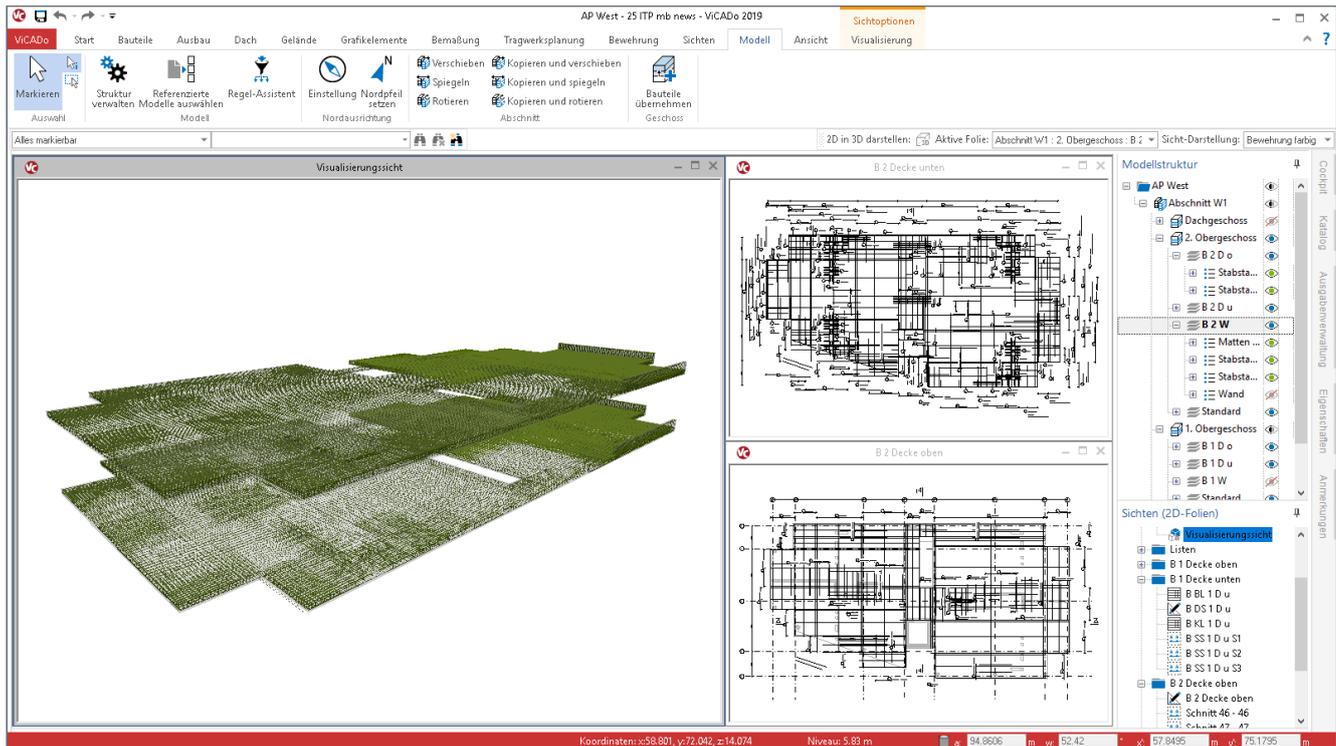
Übertragene Bewehrung und erzeugte Sichten für die Bewehrung im 2. Obergeschoss
